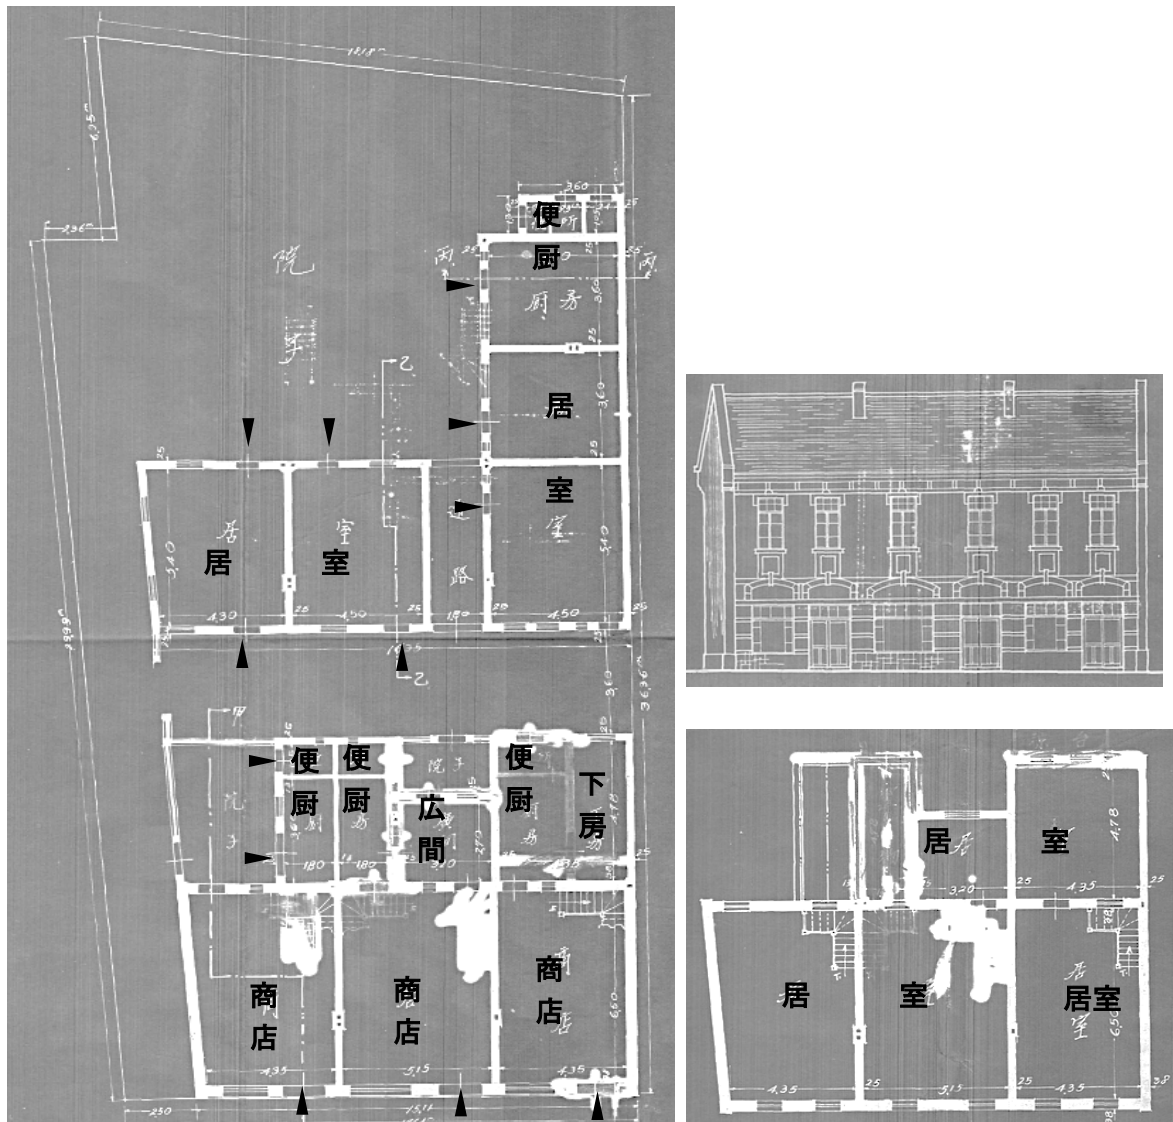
②の一階、二階平面図と立面図（「1937-0161」より）
